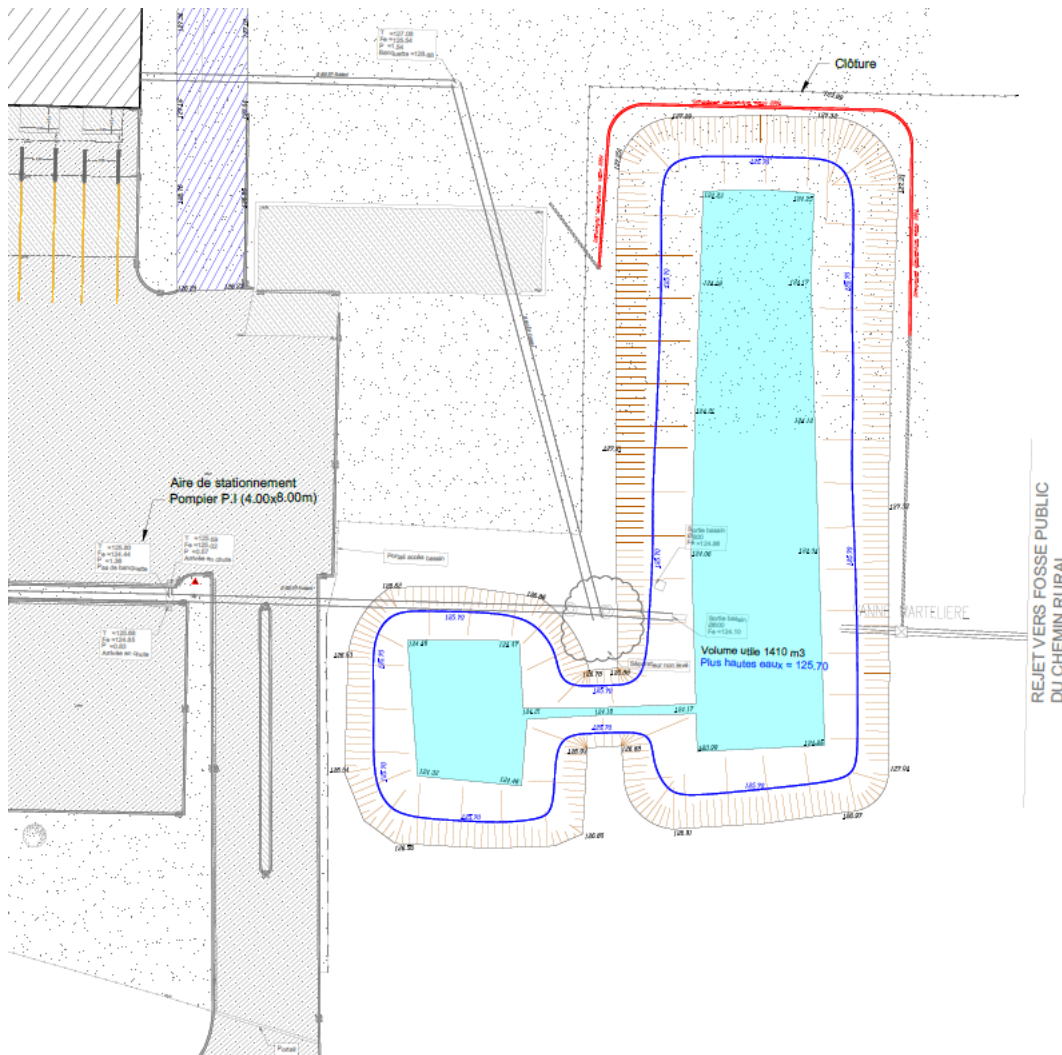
PLAN DE RECOLLEMENT VRD - ZOOM
